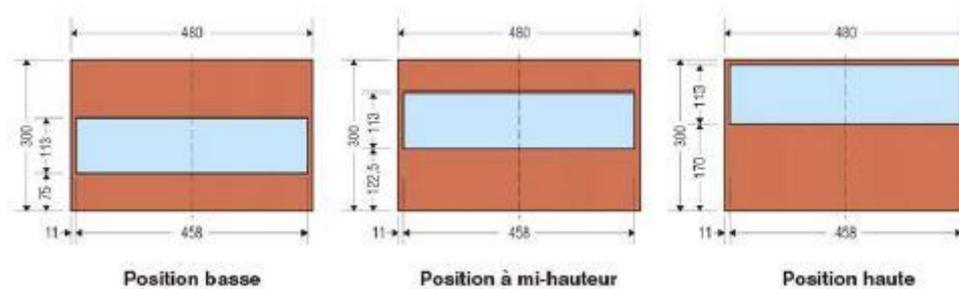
Les différents position d'une fenêtre latérale sur un plan verticale.
